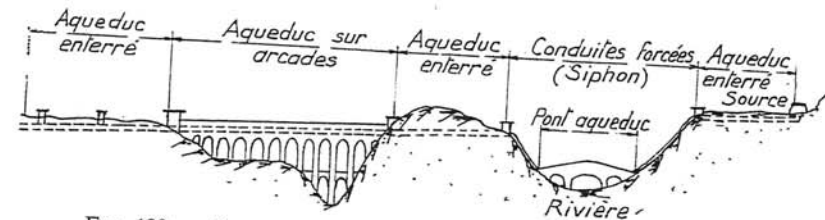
Ouvrages divers sur une adduction à plan d'eau libre.
